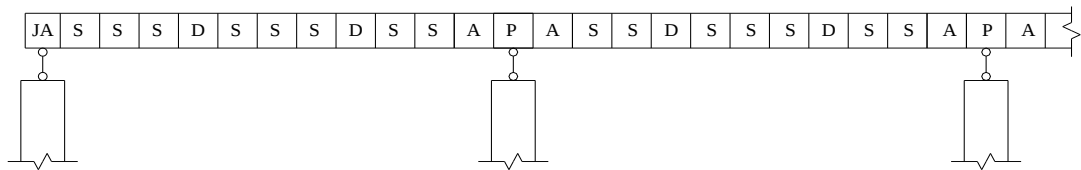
整跨拼装施工的箱梁节段布置示意图
